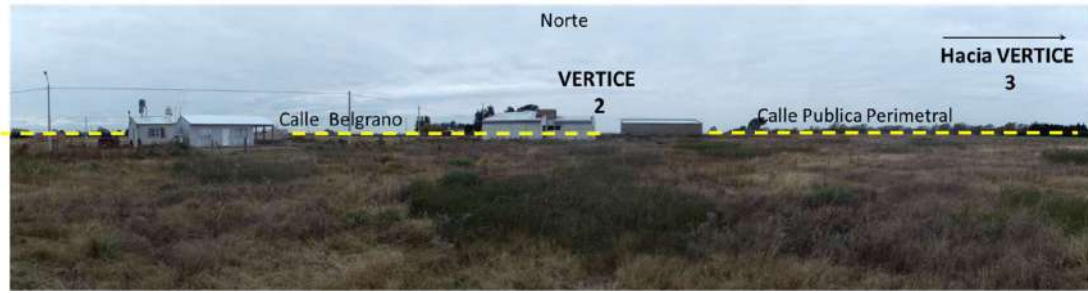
Vista intersección calles Belgrano y Calle publica perimetral.
